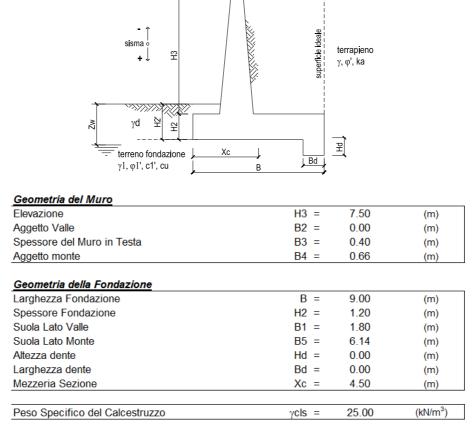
Caratteristiche geometriche muri di sostegno con fondazione diretta – tipo 3.
